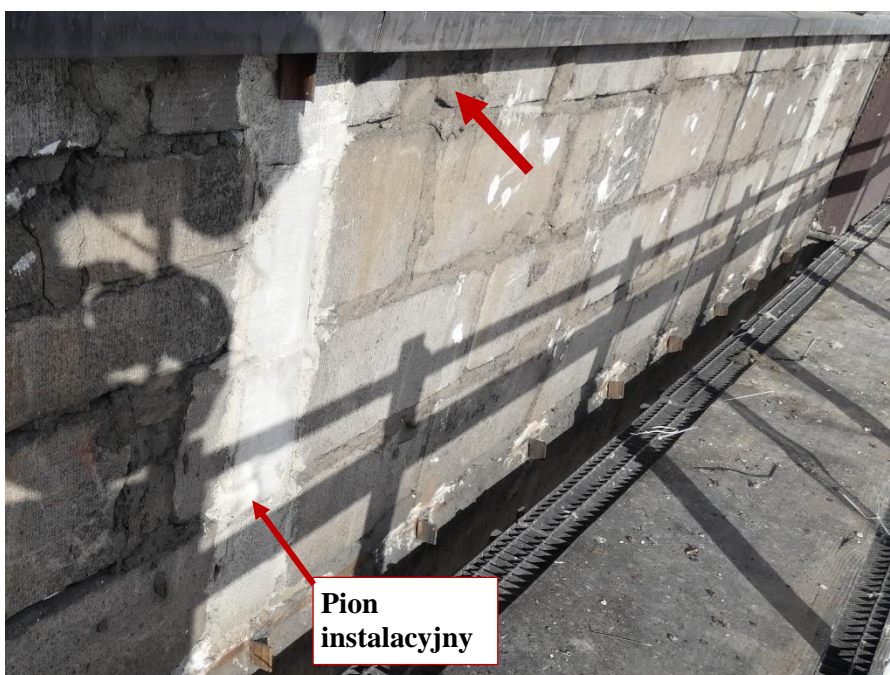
Przykład zamknięcia pionu instalacyjnego.
